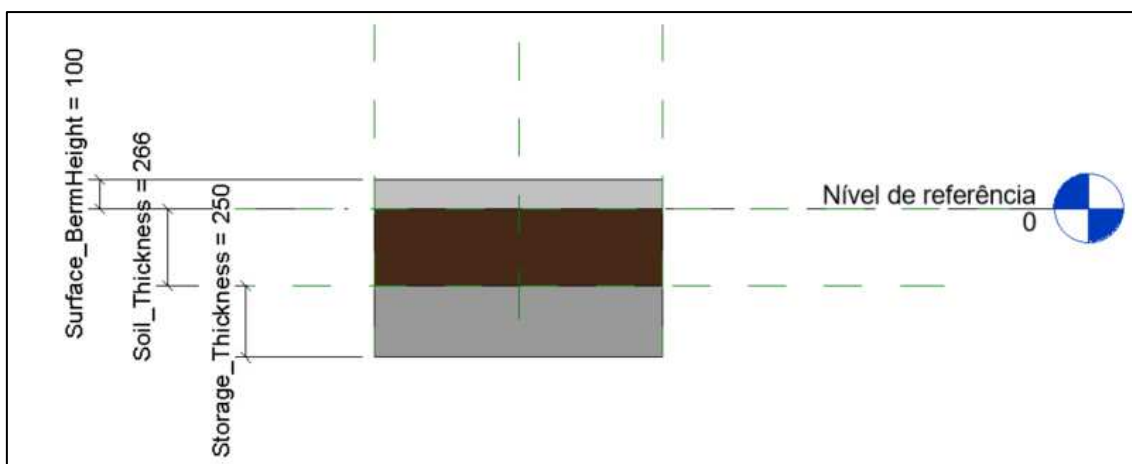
Família Revit de Jardim de chuva, vista em elevação. Fonte: Elaborado pelo Autor.
